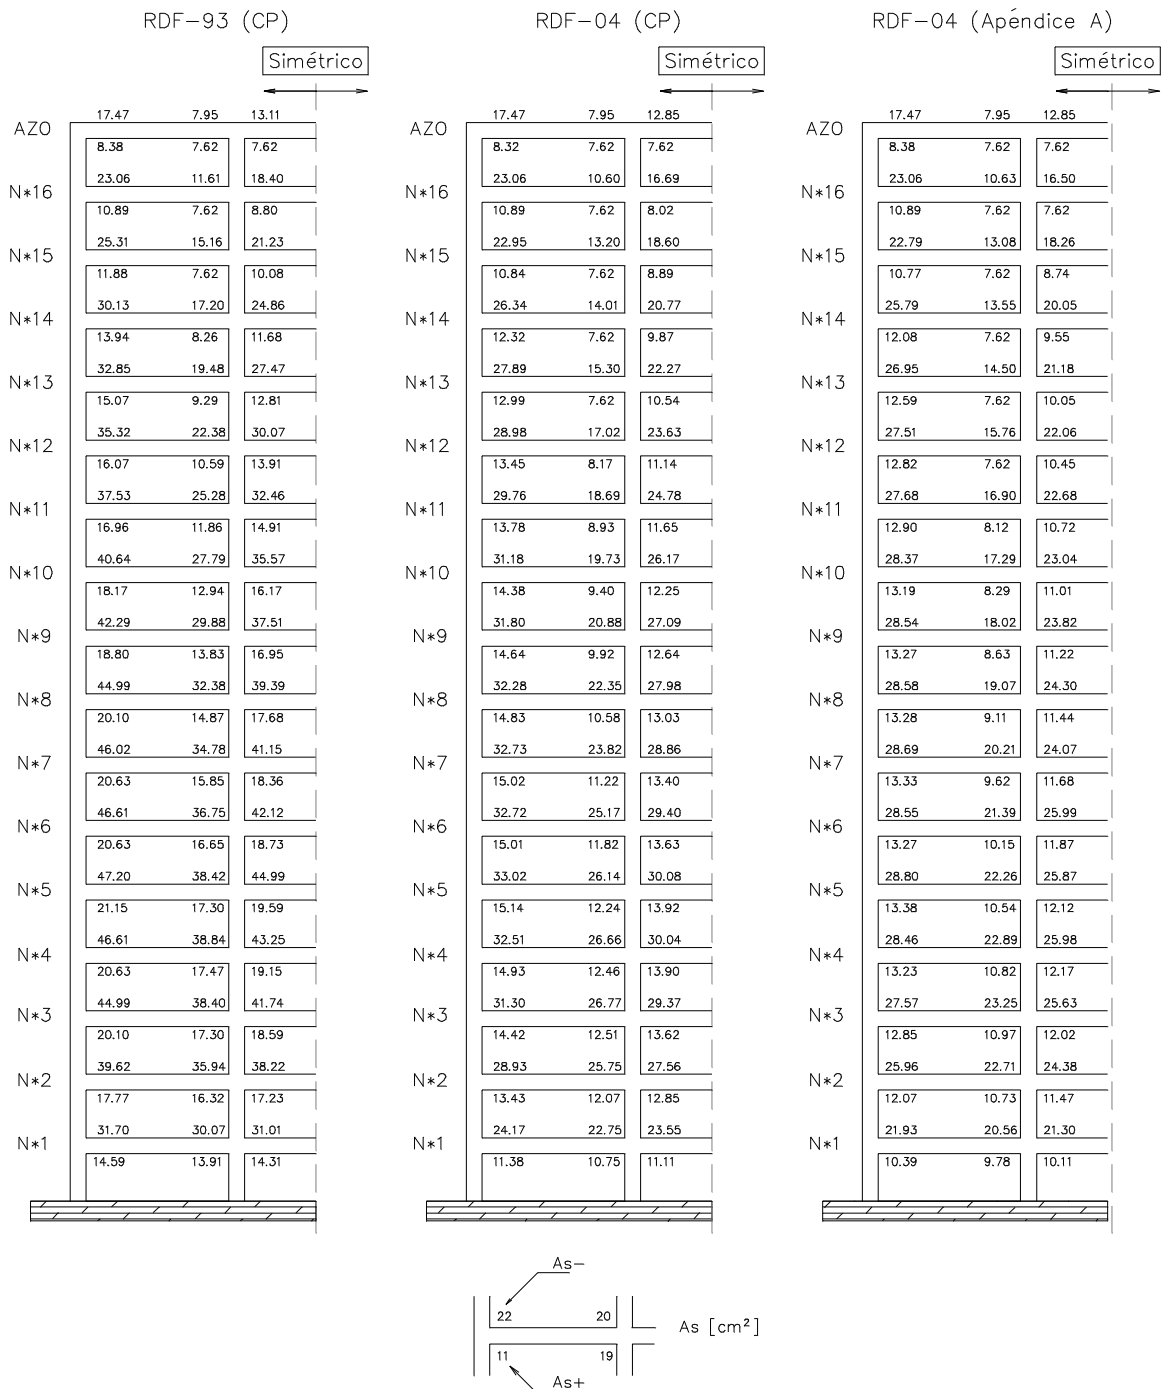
Comparación de áreas de acero de refuerzo longitudinal de los extremos de las vigas del eje 2 de las estructuras diseñadas en zona II (RDF-93 y RDF-04)
